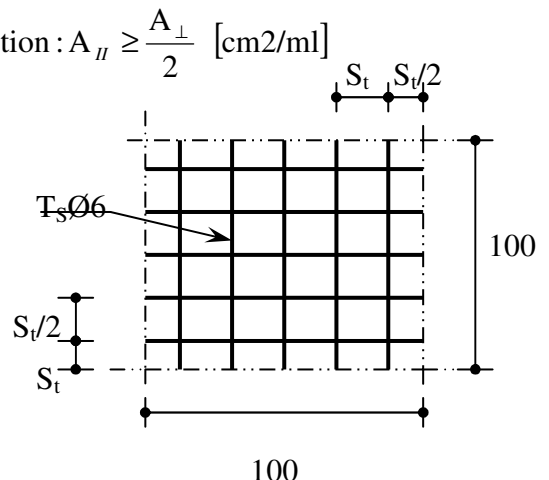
Disposition constructive des armatures de la dalle de compression
